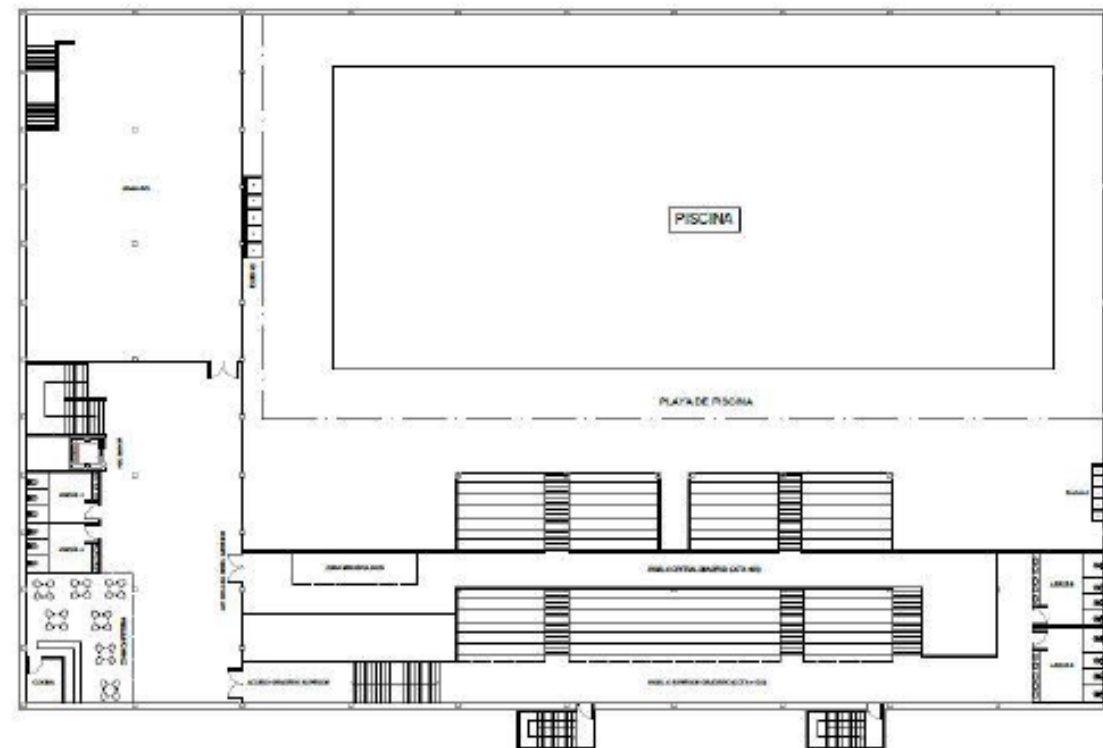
Vista de planta de la solución adoptada. Fuente: Propia
